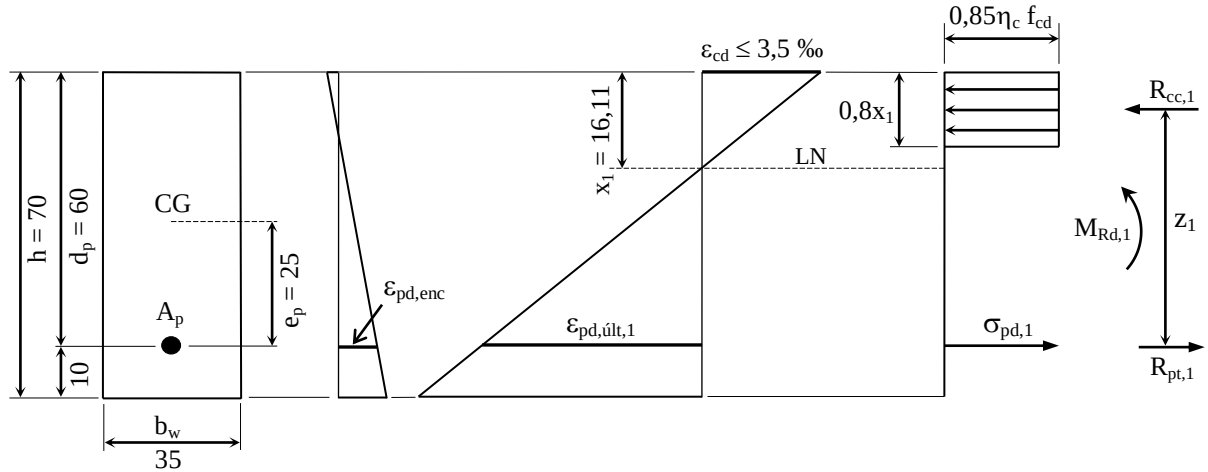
Dimensões (cm) da seção transversal da viga retangular.
